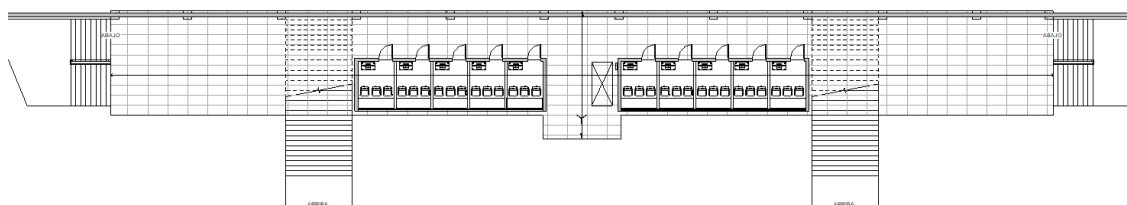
Vista en planta del tercer piso. Fuente: elaboración propia.
